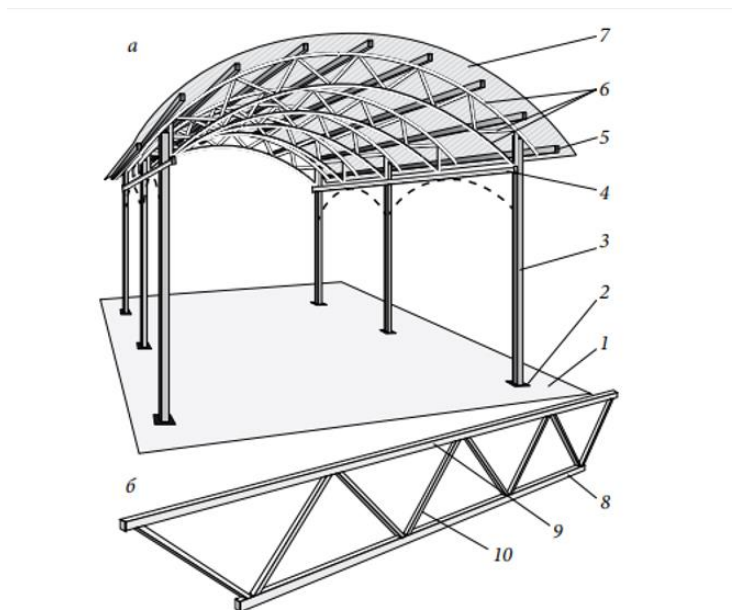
Схема конструкции навеса: а - общий вид, б - схема фермы; 1- основание; 2 - пятки; 3 - опорные стойки; 4 - балка; 5 - обрешётка; 6 - ферма арочная; 7 - настил навеса; 8 - нижний пояс; 9 - верхний пояс; 10 - раскосная решётка фермы.
